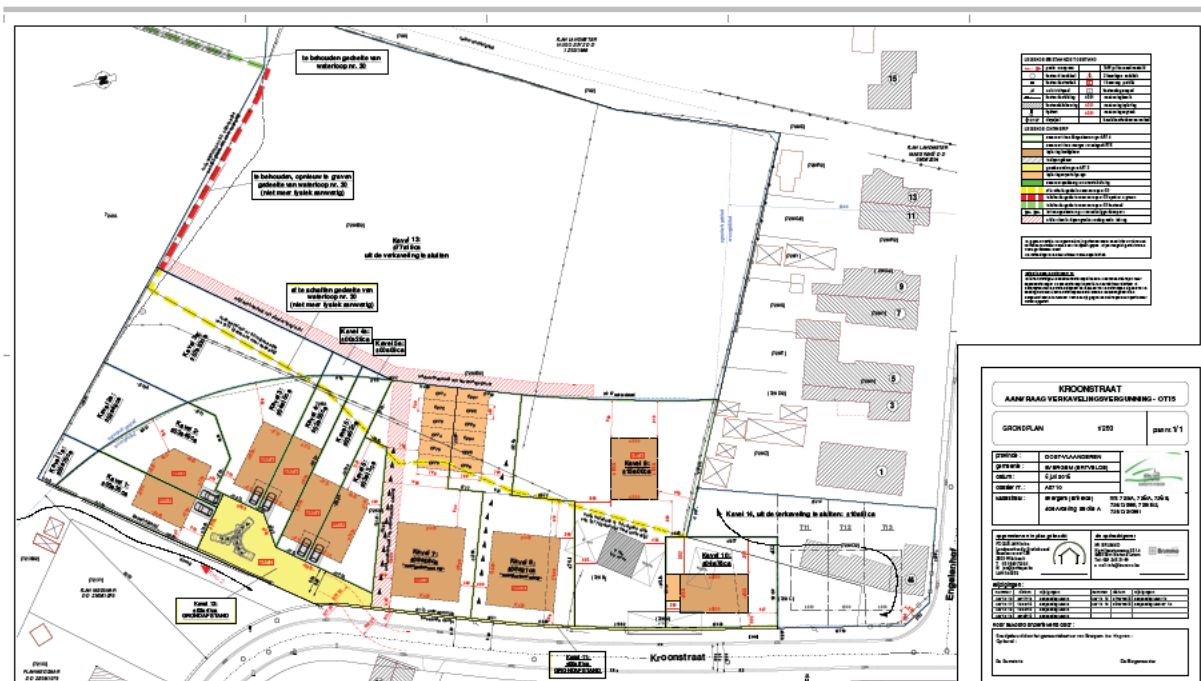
Inplantingsschema verkaveling Evergem-Kroonstraat.
